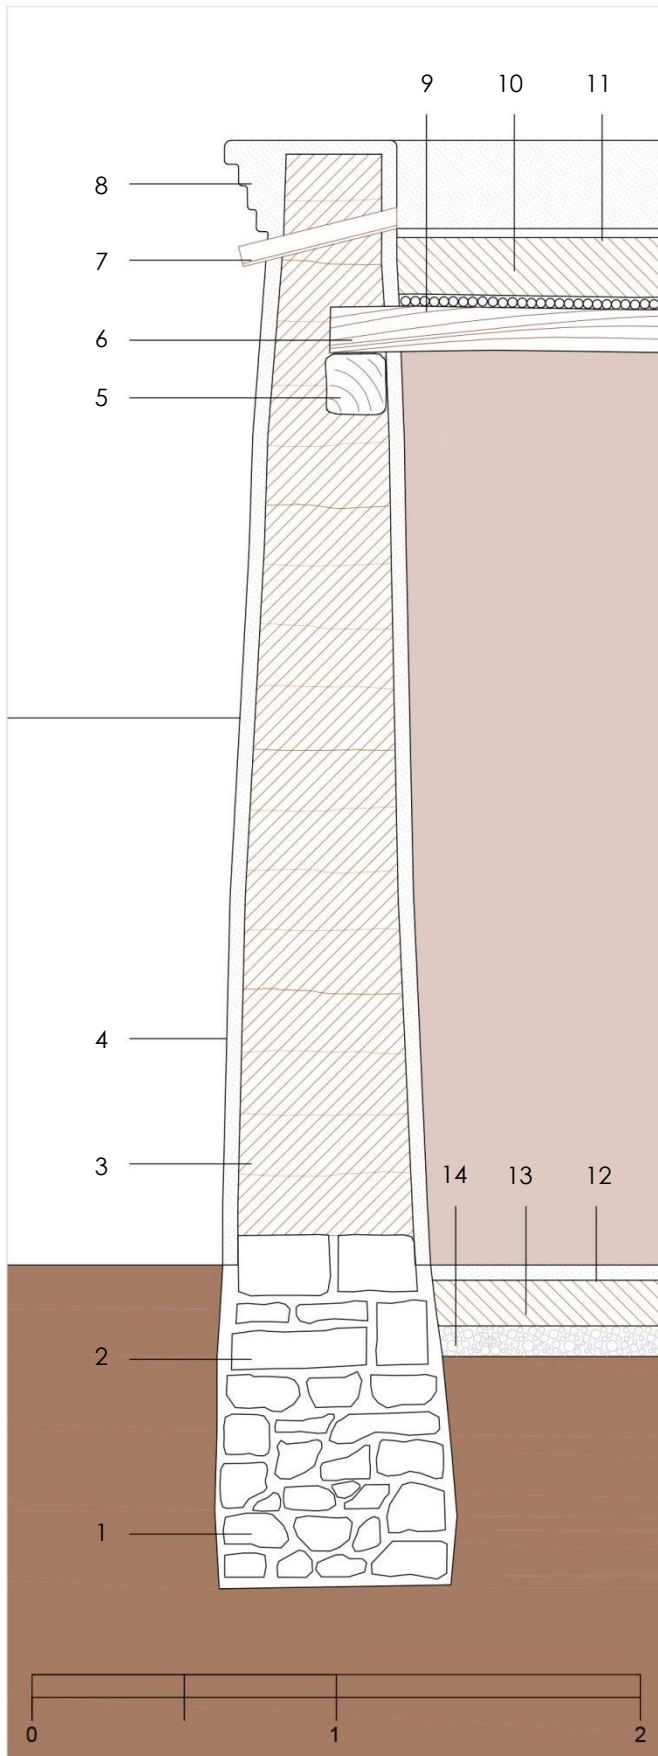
Muro de tapial. Fuente: Félix Jové Sandoval.
